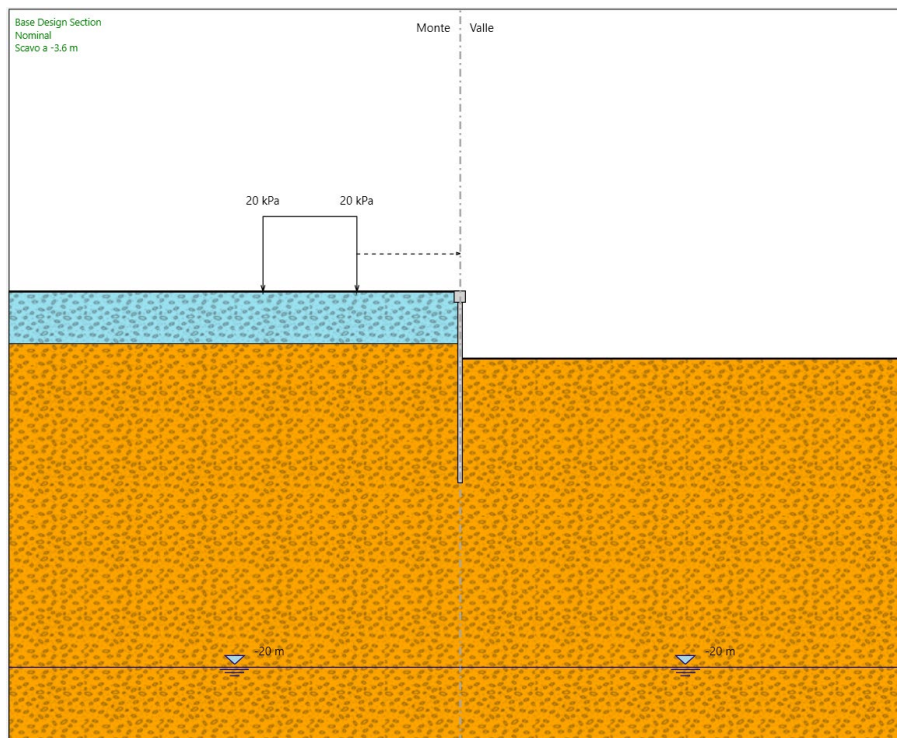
Sezione paratia a cavalletto – Sezione Tipo A1
